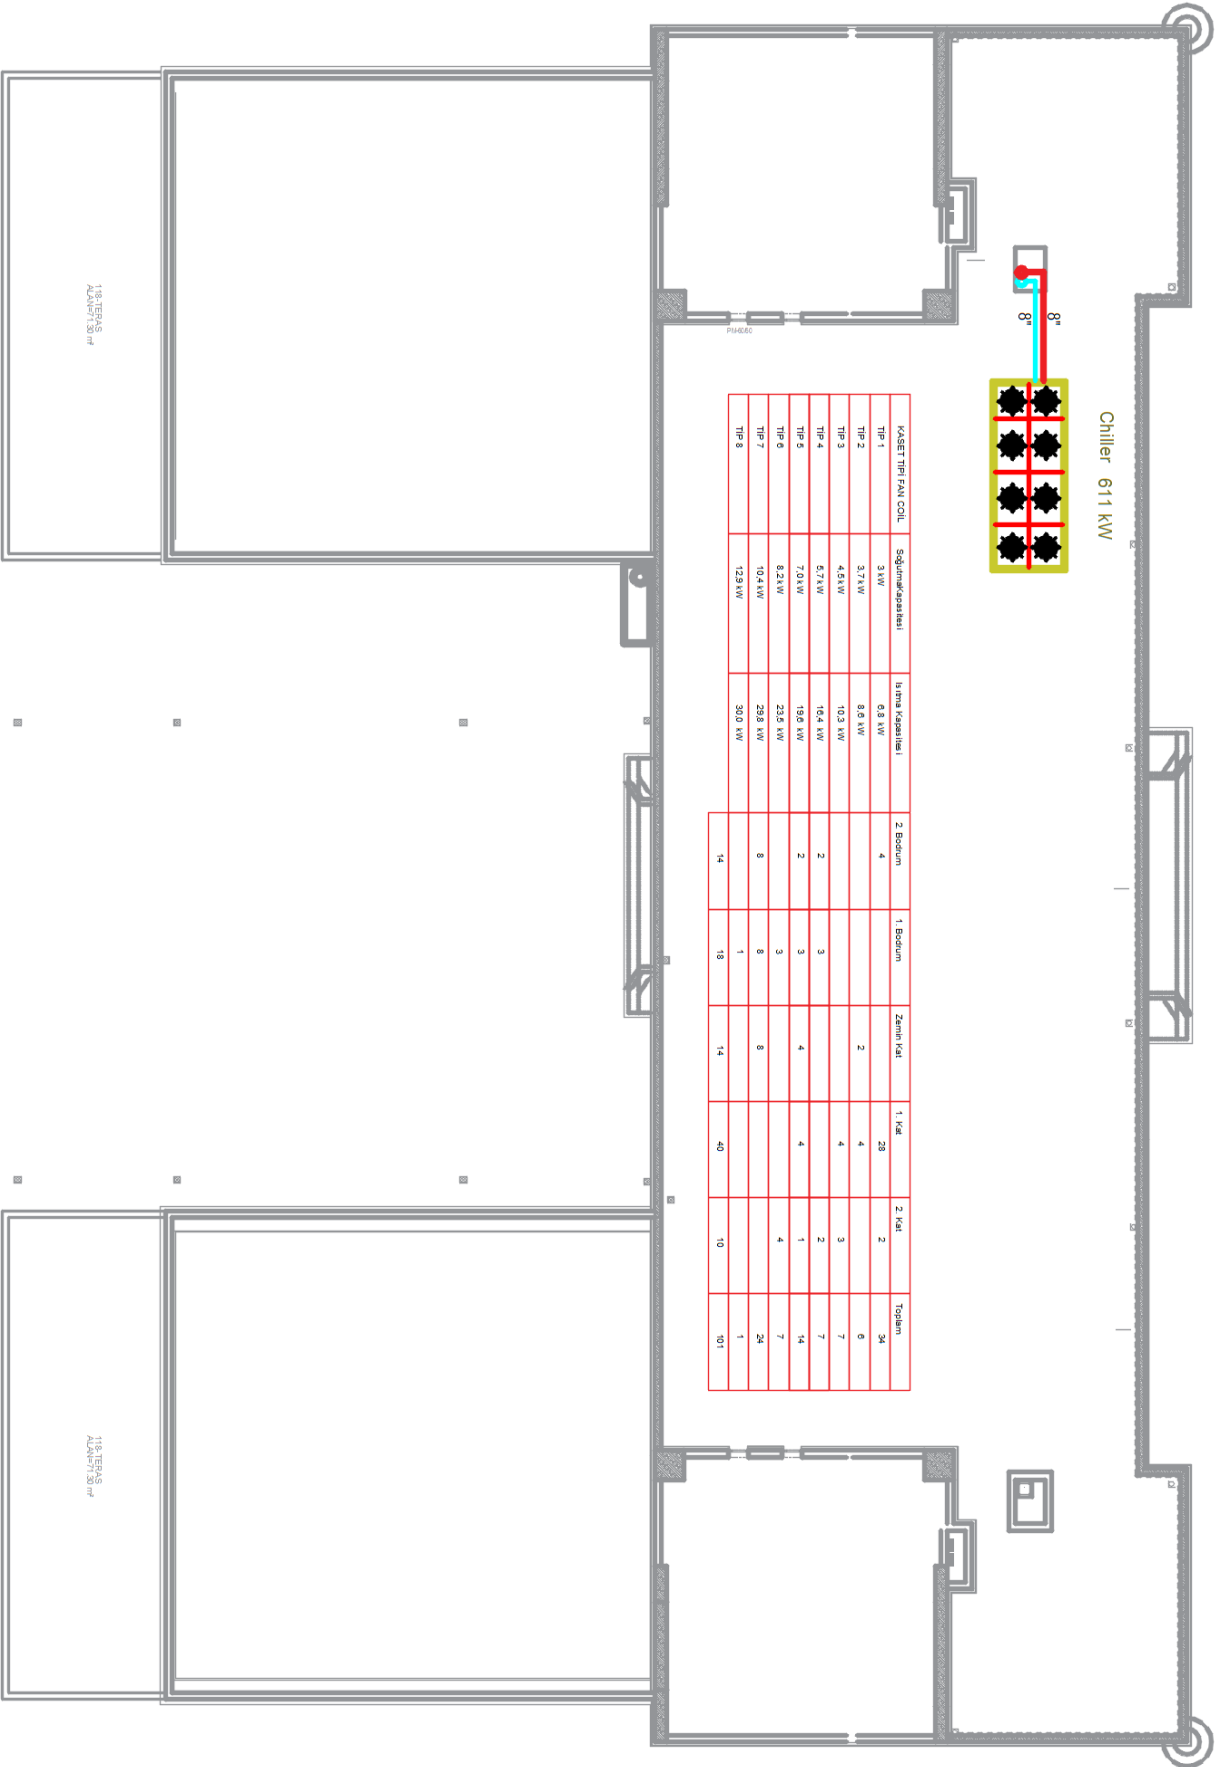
Fan coil tesisatı 1. bodrum kat planı.
